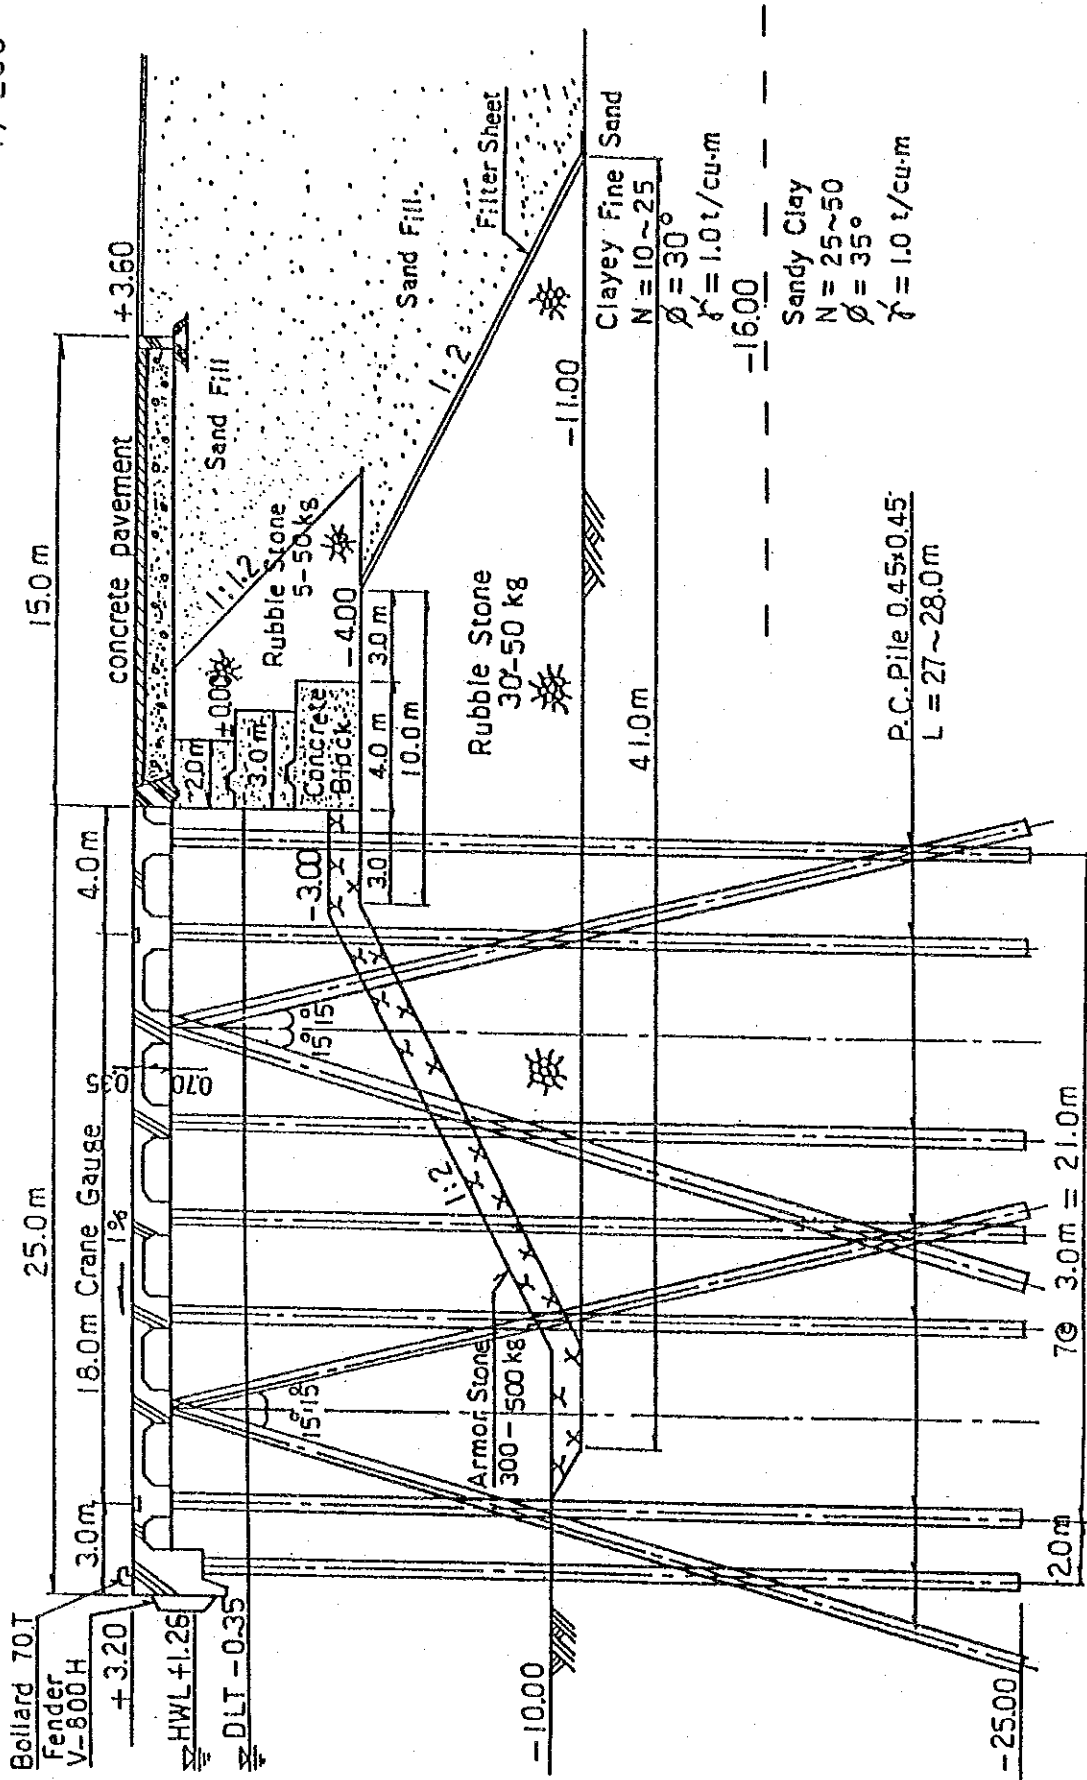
マニラ北港-10mコンテナバース標準断面図
